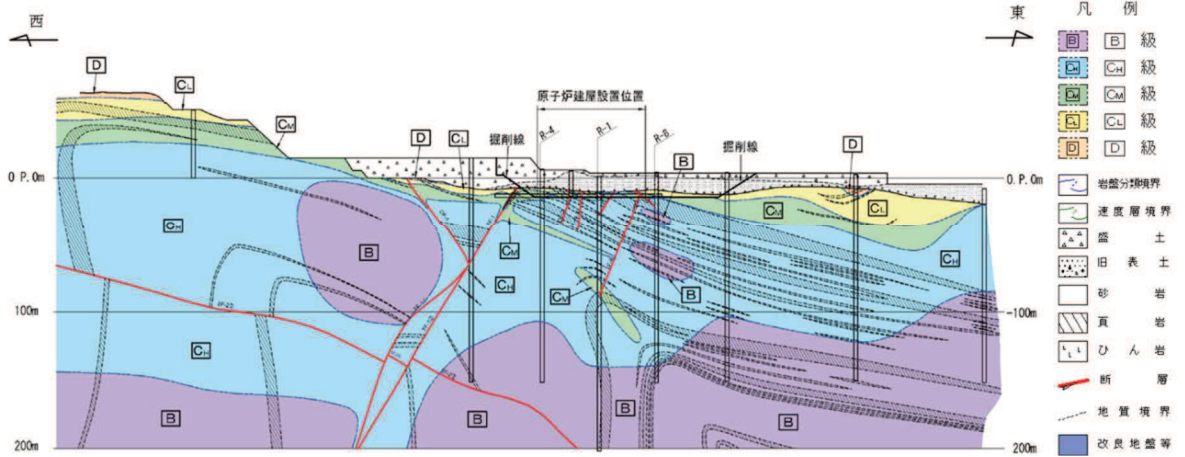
(1) 原子炉建屋の地質断面図 (①-①断面)
